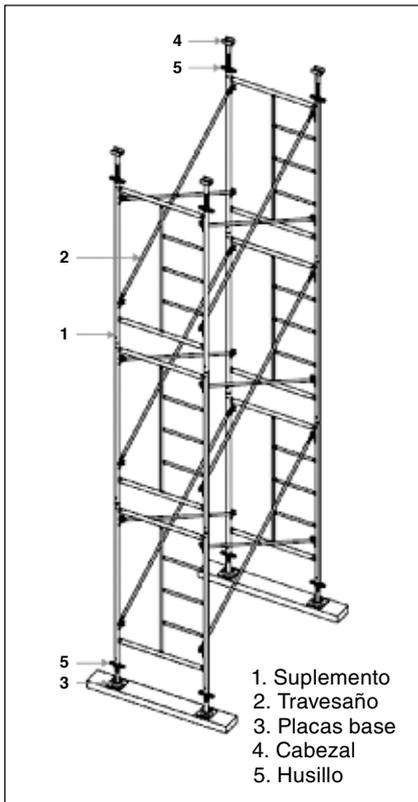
Cimbra ligera para edificación. Detalle de componentes.
